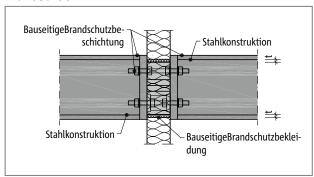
Brandschutz Schöck Isokorb® T Typ S: Bauseitige Brandschutzbekleidung T Typ S, brandschutzbeschichtete Stahlkontruktion; Schnitt
